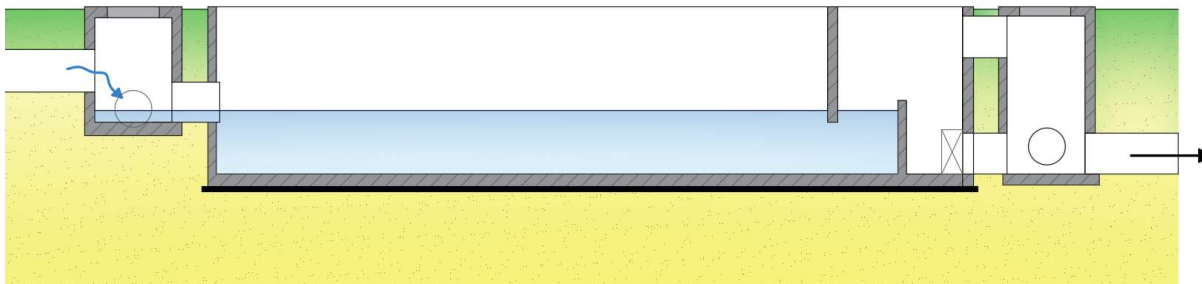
Przykładowe schematy zbiorników infiltracyjnych oraz zbiorników retencyjno-infiltracyjnych
